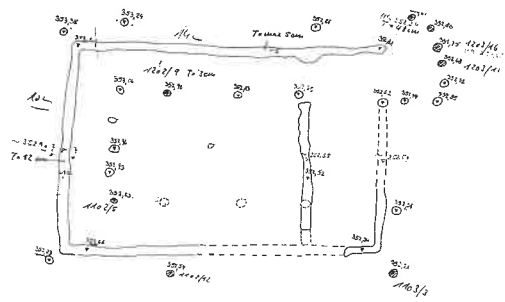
Grundriss des Wohnhauses (archäologische Aufnahme), M. 1:100.
